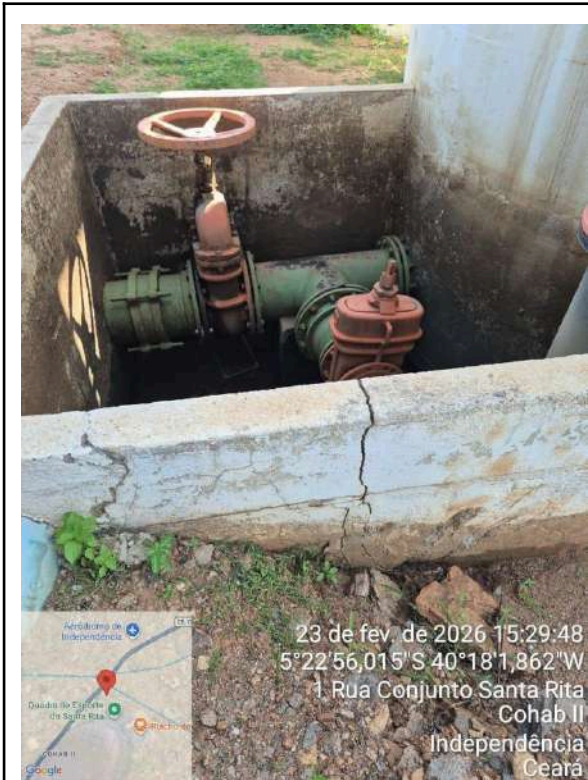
F-01: presença de vazamento no filtro e na estrutura e rachadura na parede da caixa.
